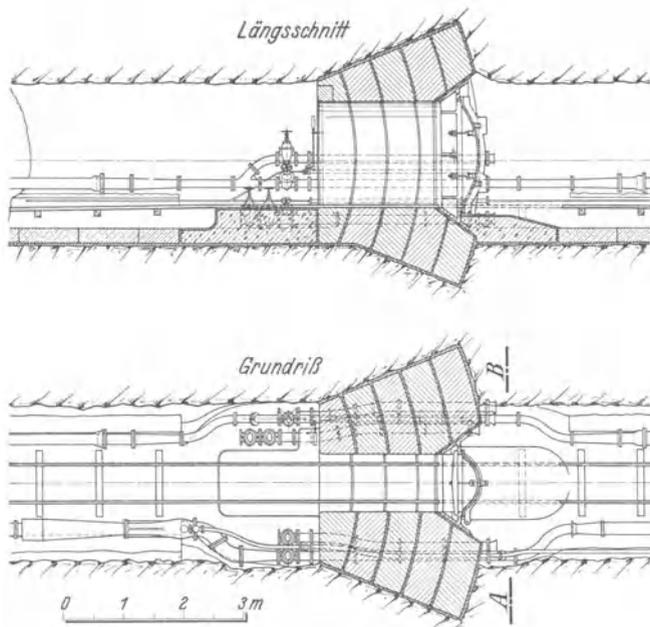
Dammverschluß im Kellerkopfstollen. (Längsschnitt und Grundriß.)
